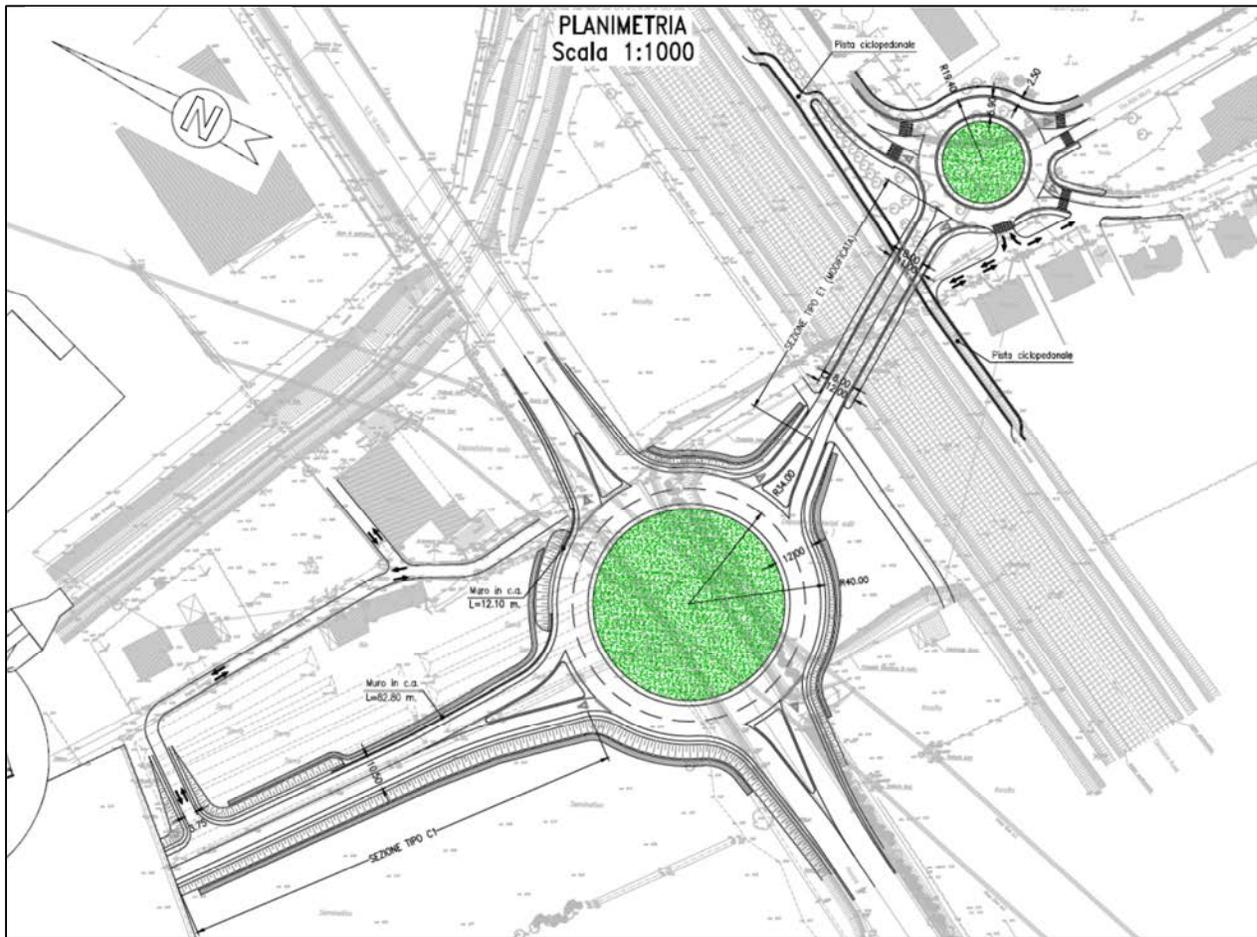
a – planimetria degli interventi indicati A e B – estratto da planimetria 1:1000
